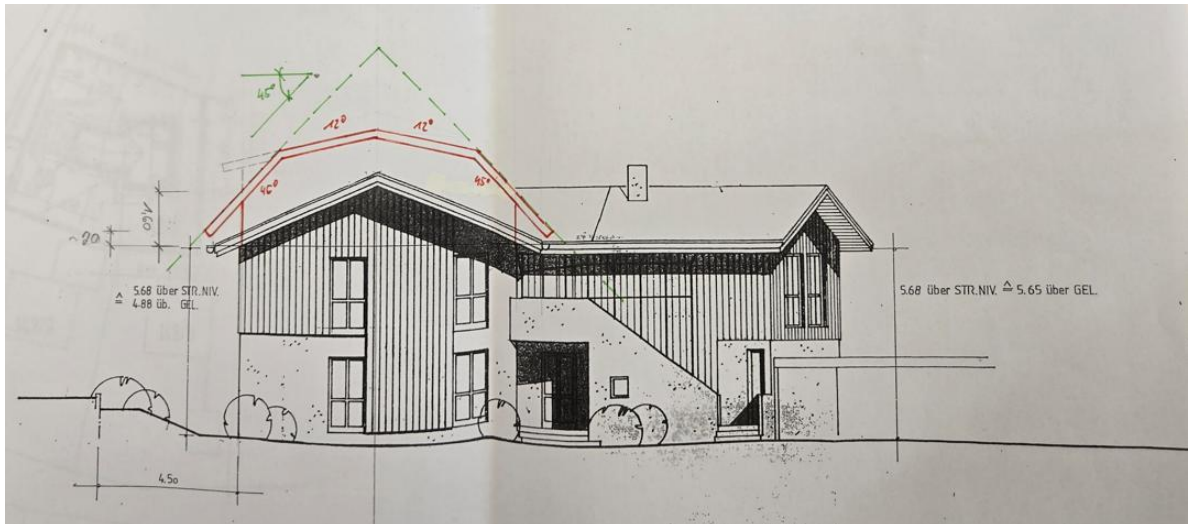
Ansicht Nord mit geplanter Erhöhung
